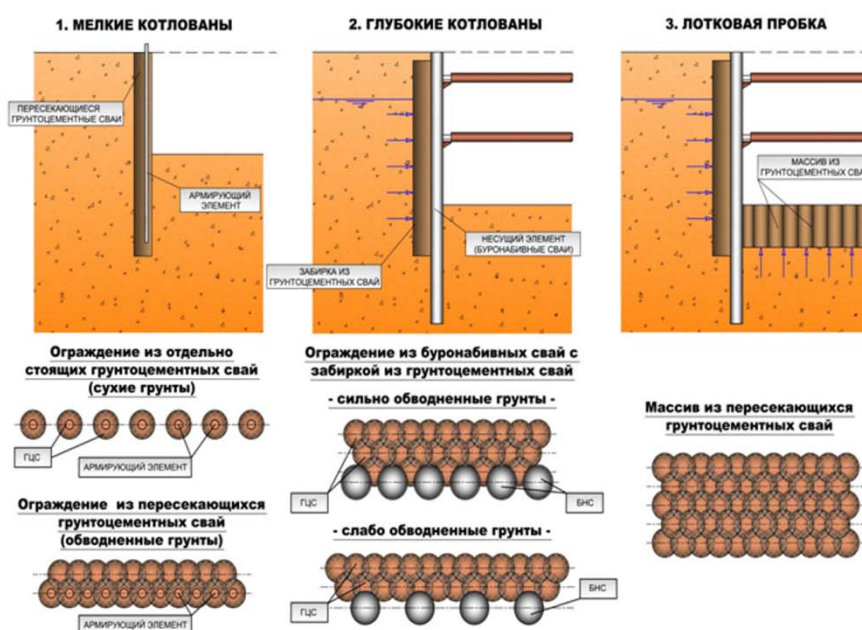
Варианты использования технологии «JET-GROUTING» для создания ограждающих конструкций котлованов.
